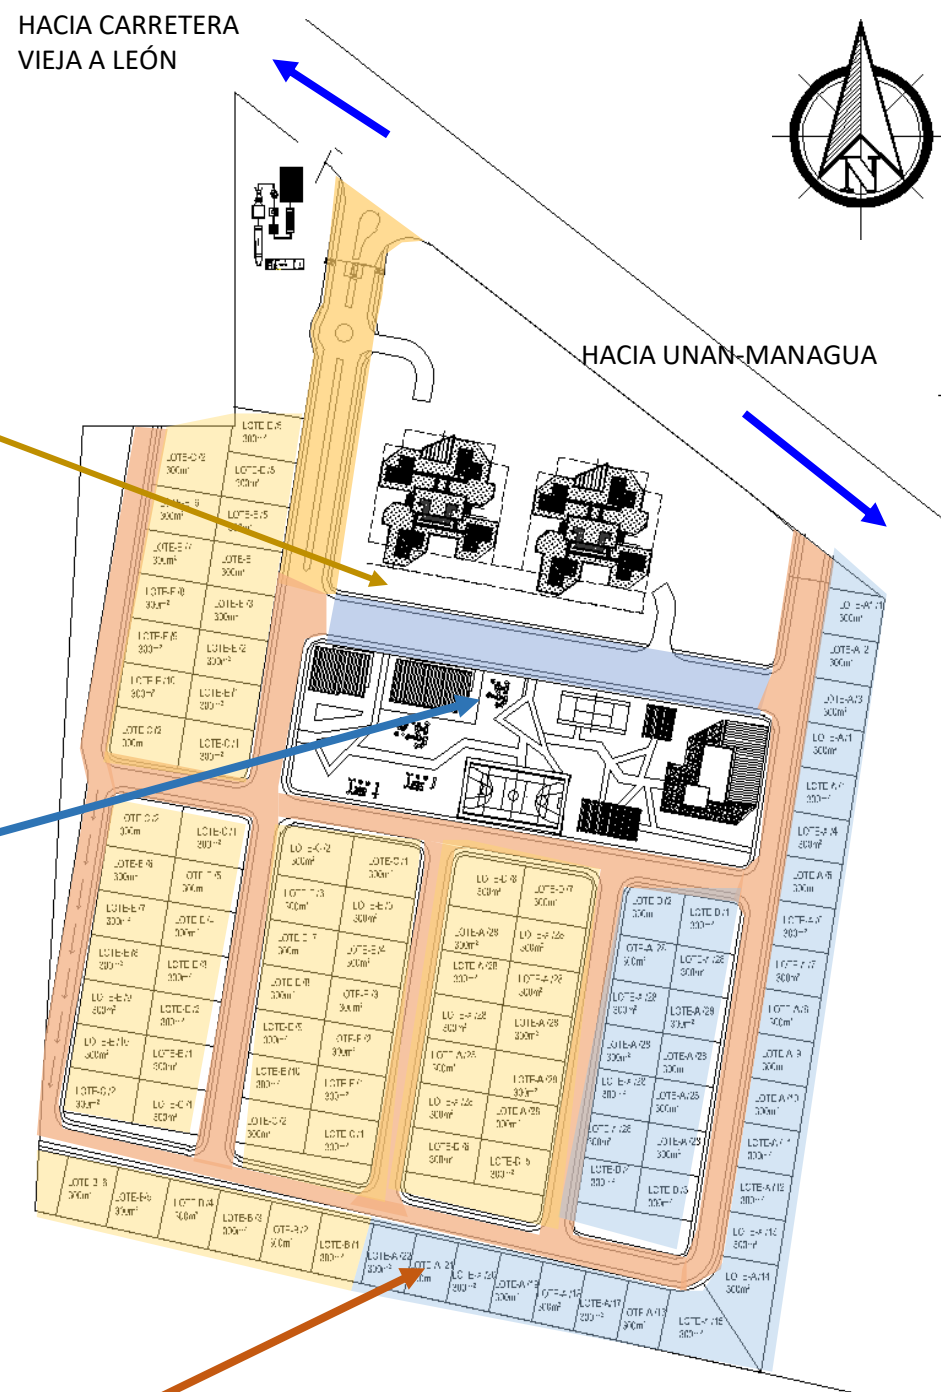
Plano de conjunto mostrando los accesos, y vías vehiculares del conjunto. Fuente: Fuente Propia
